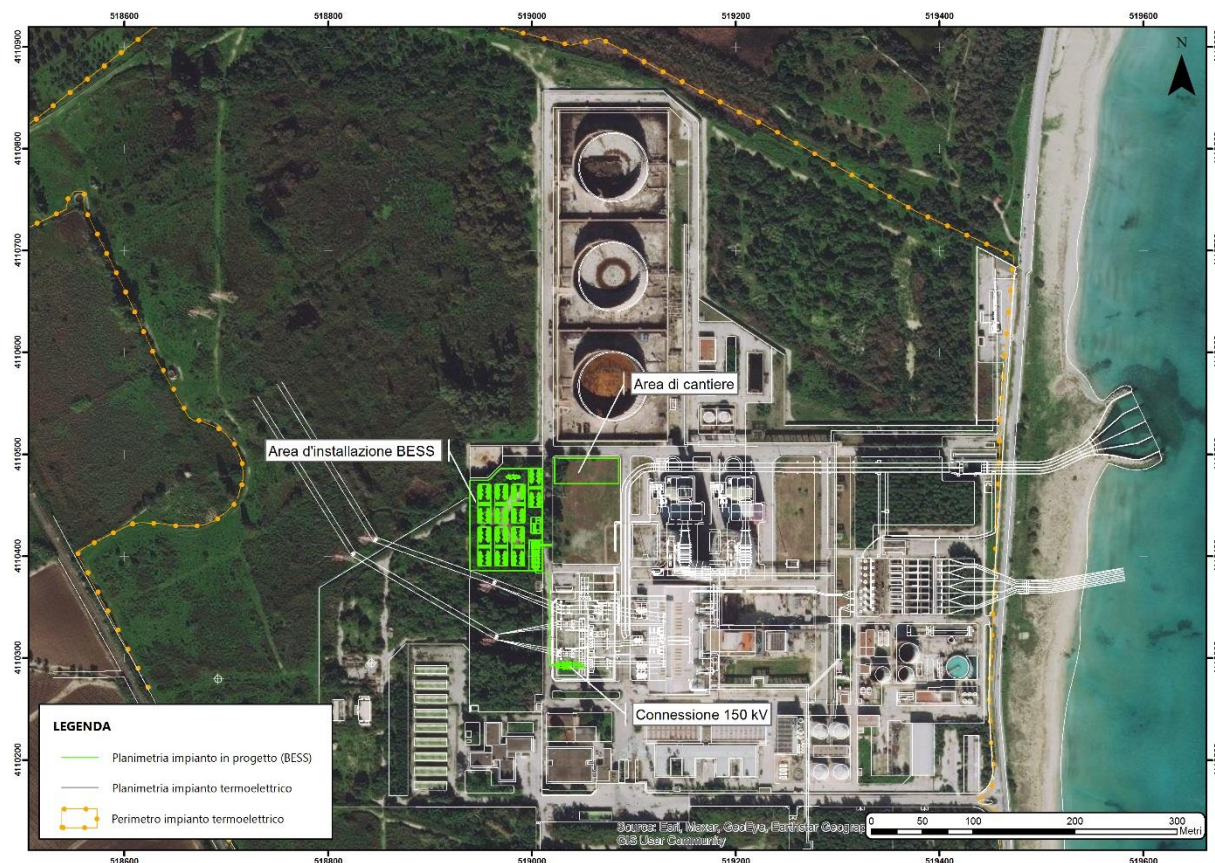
Ubicazione dell'area d'intervento rispetto al sedime d'impianto.
